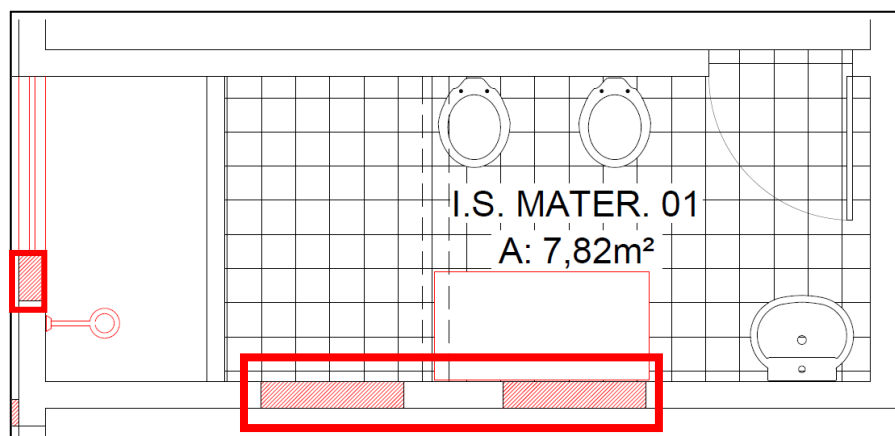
Em vermelho, parede de alvenaria a ser fechada
